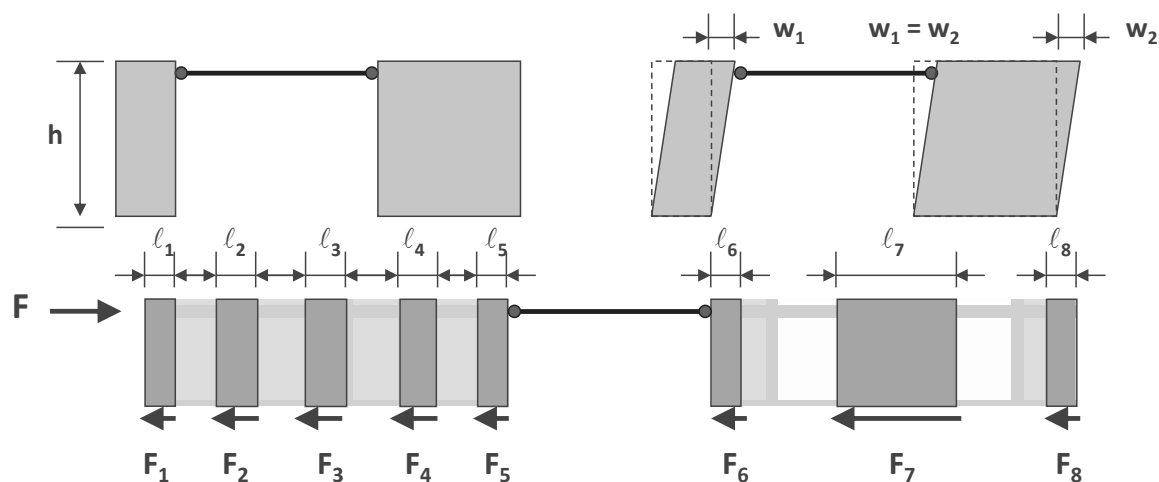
Distribuzione delle forze proporzionale alla lunghezza orizzontale delle parti di parete
